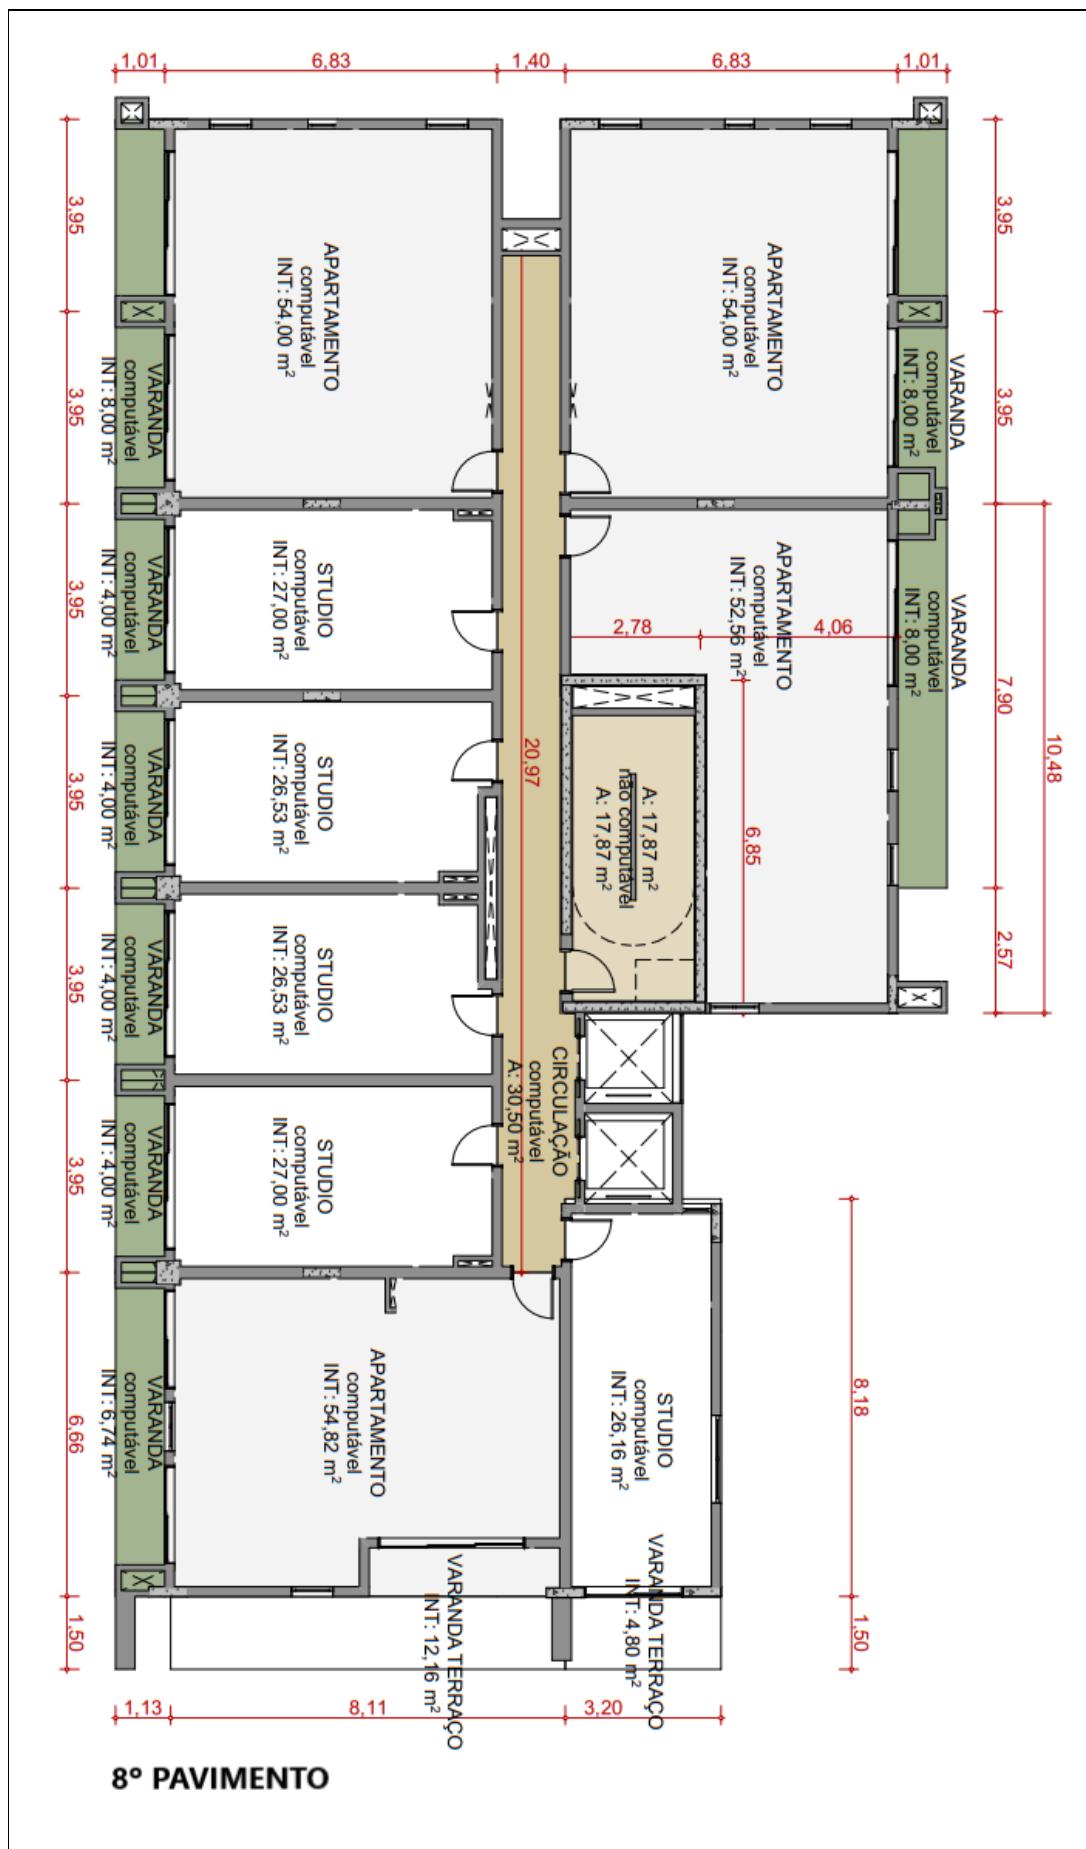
Planta do 8º Pavimento do Condomínio Sintropia Sky Garden.
